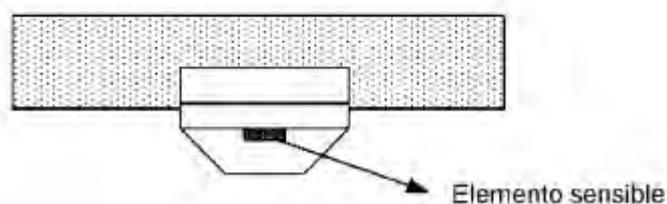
Emplazamiento y separación bajo falsos techos.
